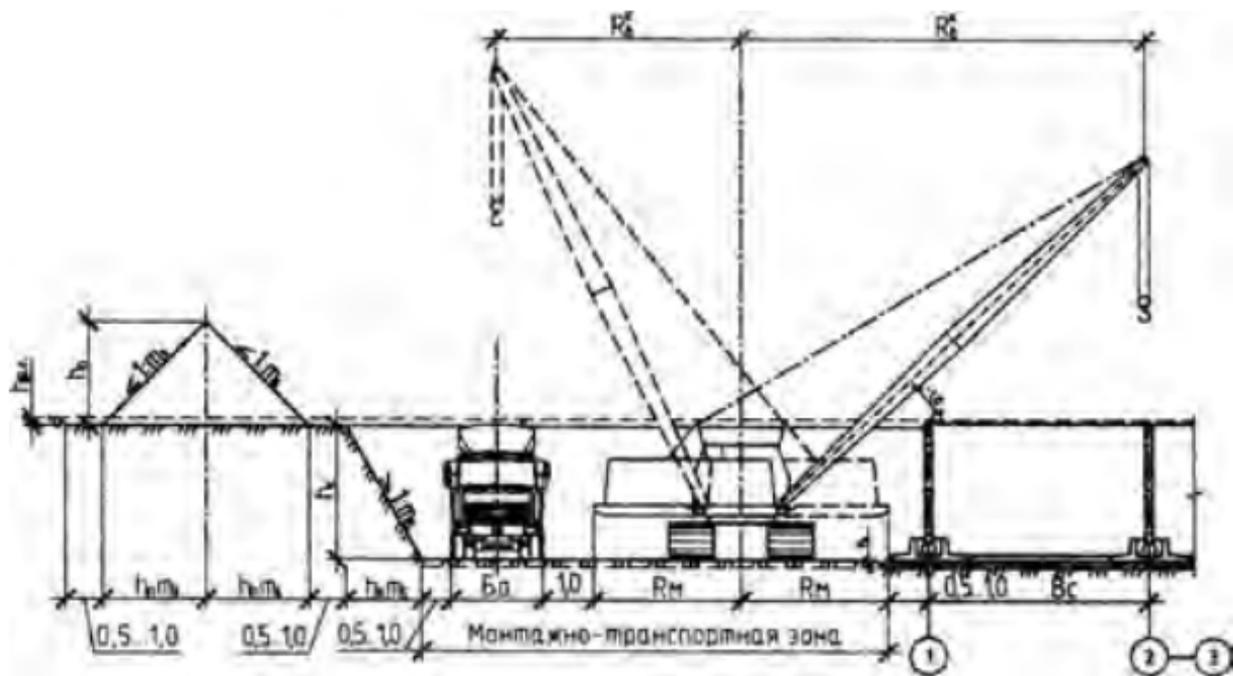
Размеры котельной и относительно кавальера грунта для монтажной схемы III
